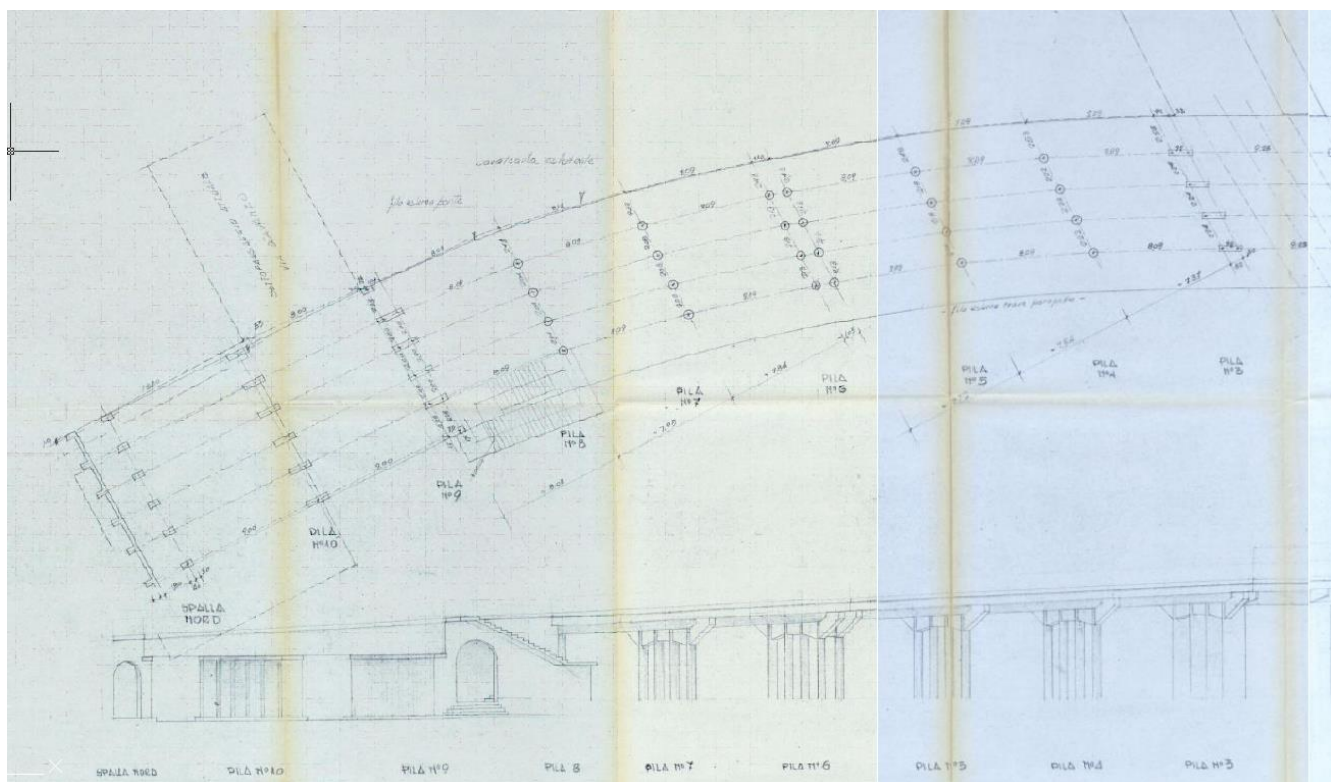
Pianta e prospetto laterale – Estratto da tavola costituente il progetto originale
